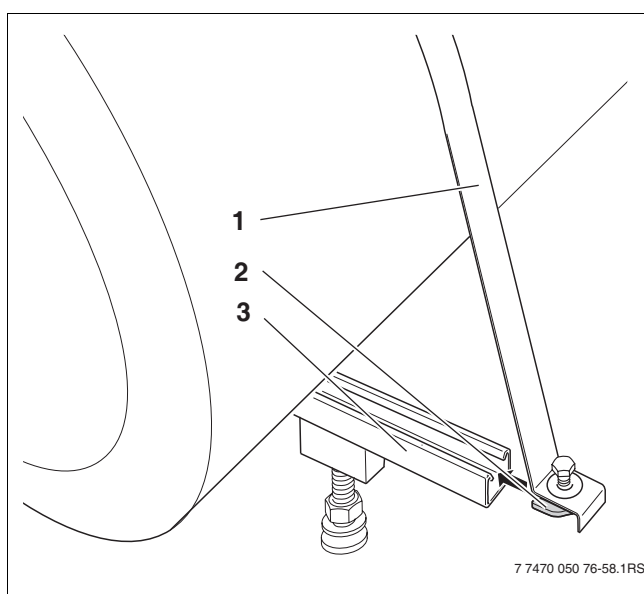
Vista da instalação para coberturas de telhados (aqui, sistema de 300 l)
